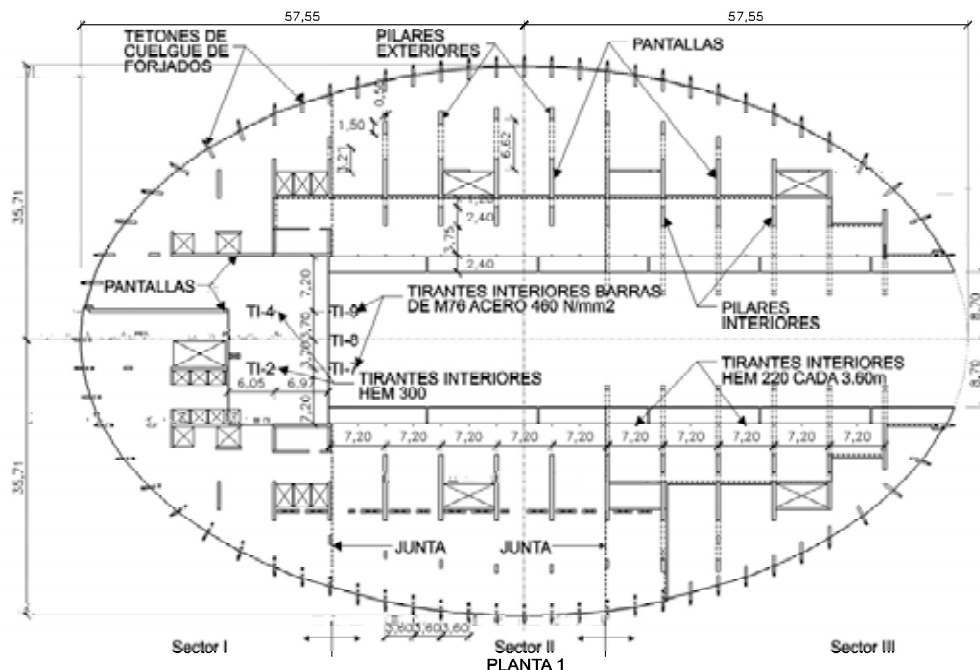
Planta 1. Forjado elíptico de semieje mayor 57,55 m y 35,71 m de semieje menor.
